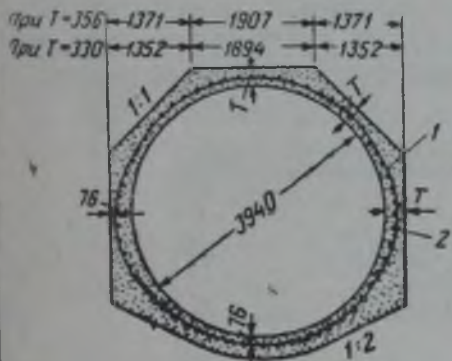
Типовая цилиндрическая железобетонная труба для люка
